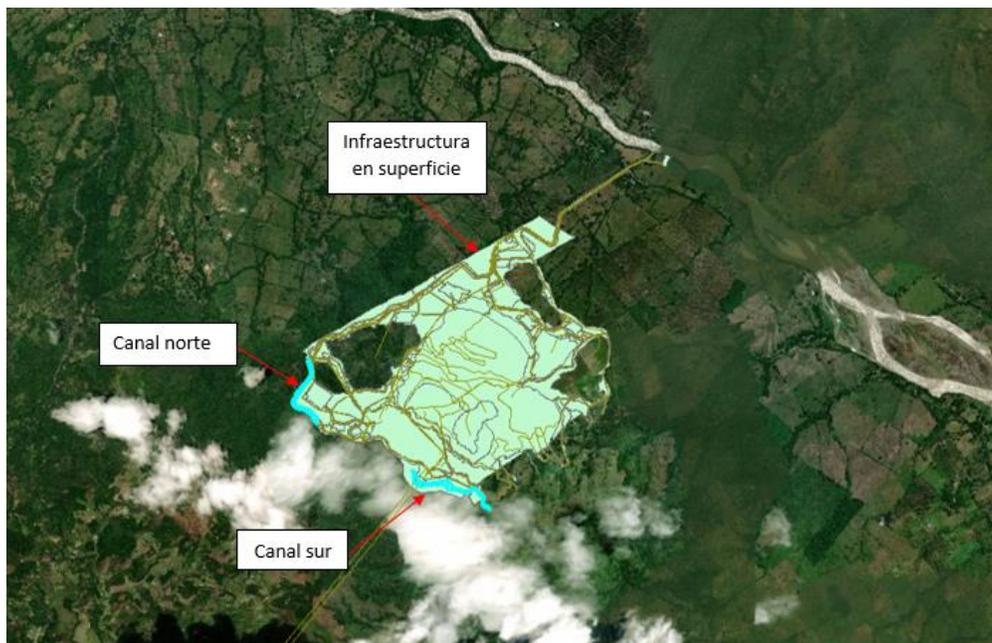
Canales perimetrales proyectados. (Fuente: EIA AGA, 2020)
